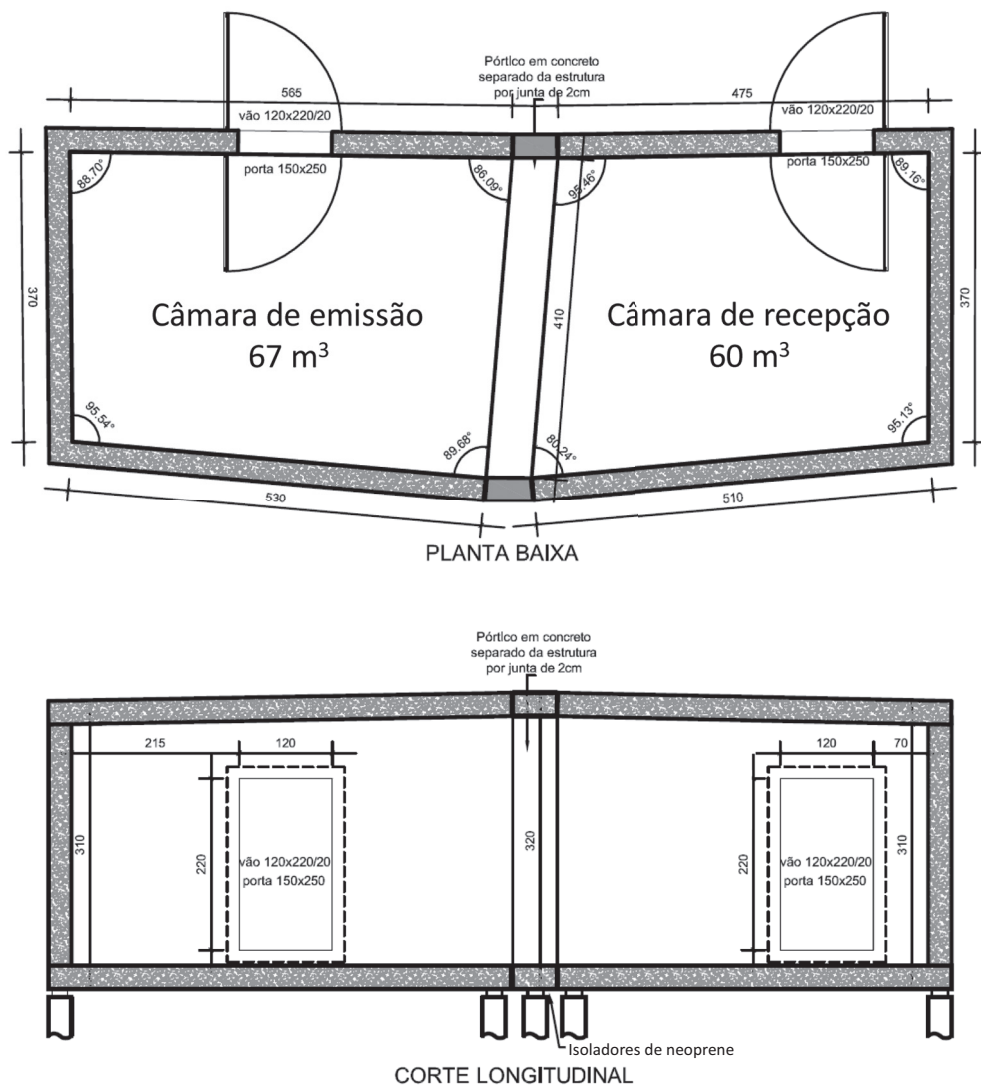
Planta baixa e corte longitudinal das câmaras de ensaio de isolamento sonoro de vedações verticais.
